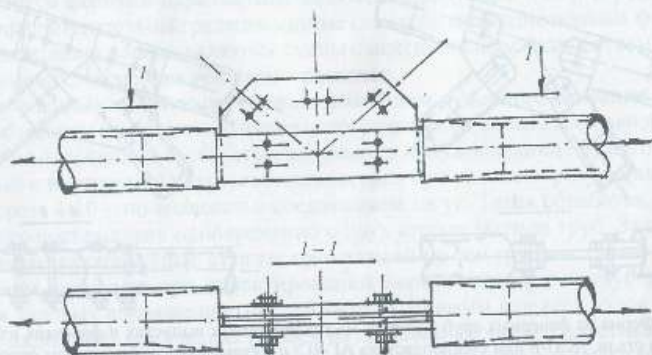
Узел нижнего пояса с неразрезными выпусками, объединяющими две соседние пробки
